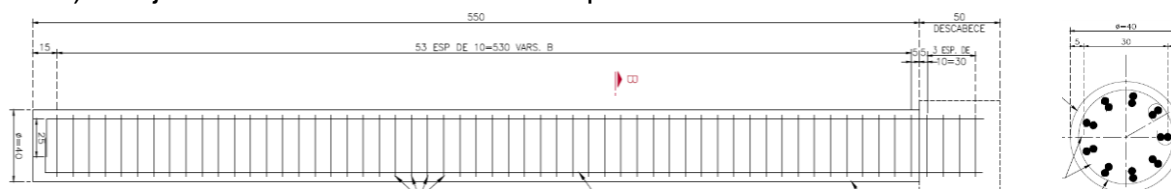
ARI Ingeniería (2023) "Sección de armado de acero longitudinal y transversal de pilas secantes, sistema de contención para excavación de zapatas"
